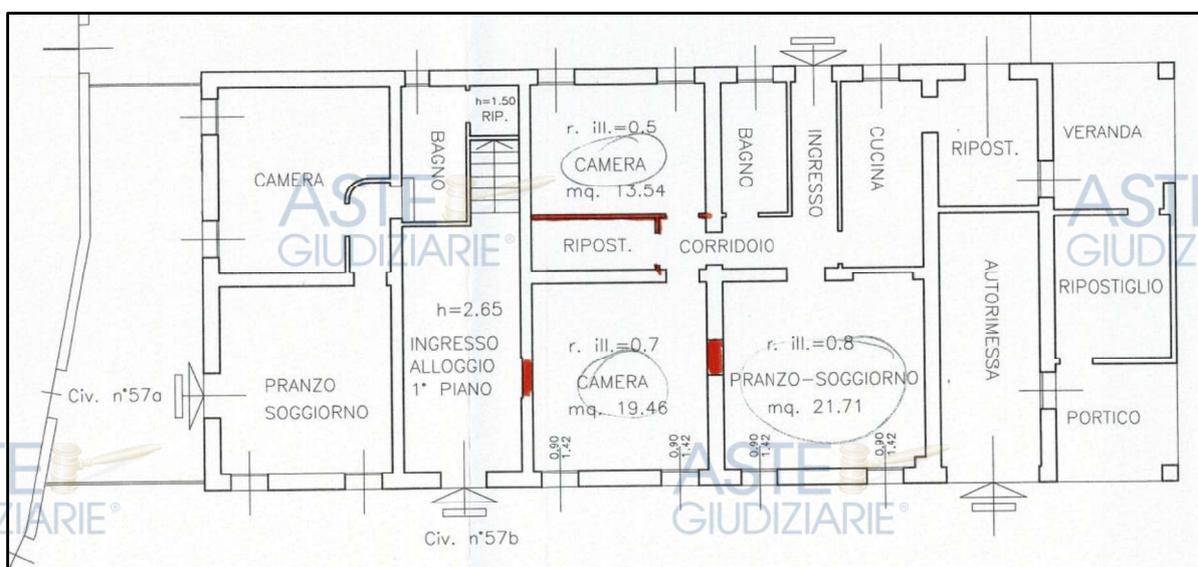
Estratto dalla DIA n. 195/99 – Stato di progetto (in rosso pareti da costruire)
